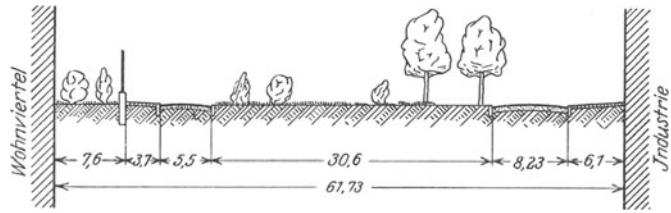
Trennung des Industrie- vom Wohnviertel durch Straße mit Grünanlagen.
